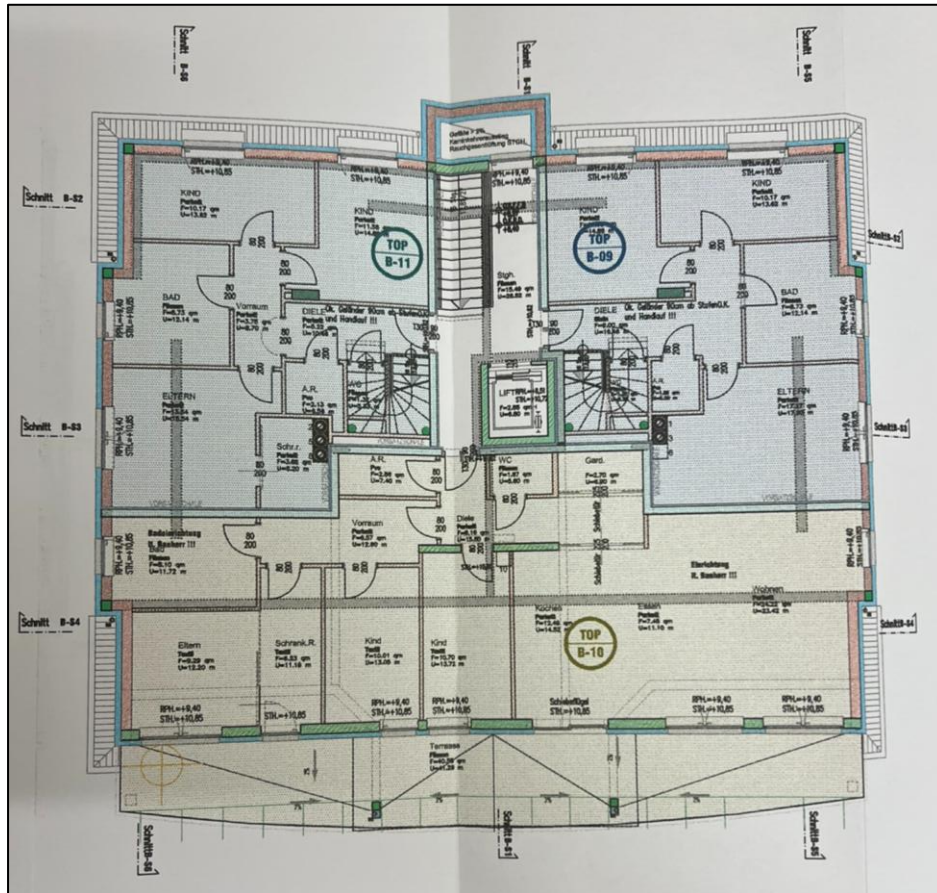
Grundriss 3 OG¹⁰
